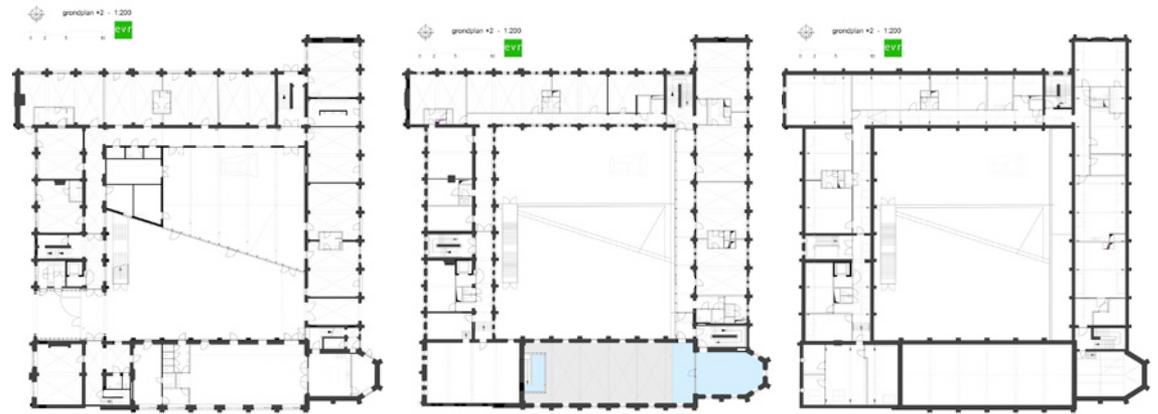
Plantas baixas do edifício (esquada para direita): Pavimento térreo/ Segundo Pavimento/ Terceiro Pavimento
